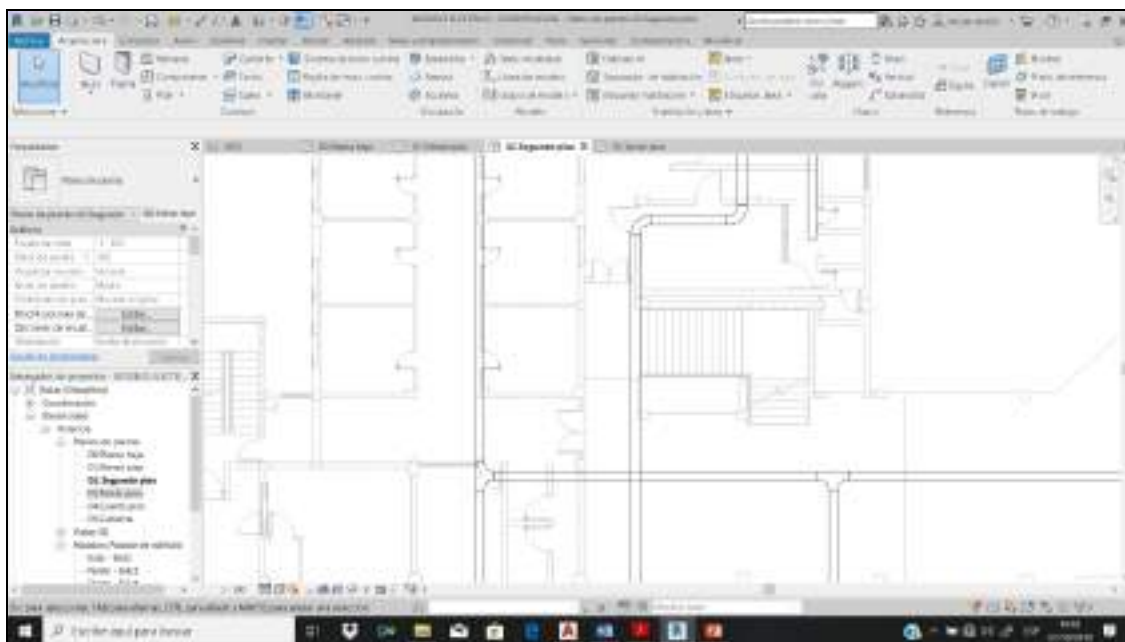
Modelado de Instalaciones eléctricas (Bandeja de Cables -Vista en Planta)
